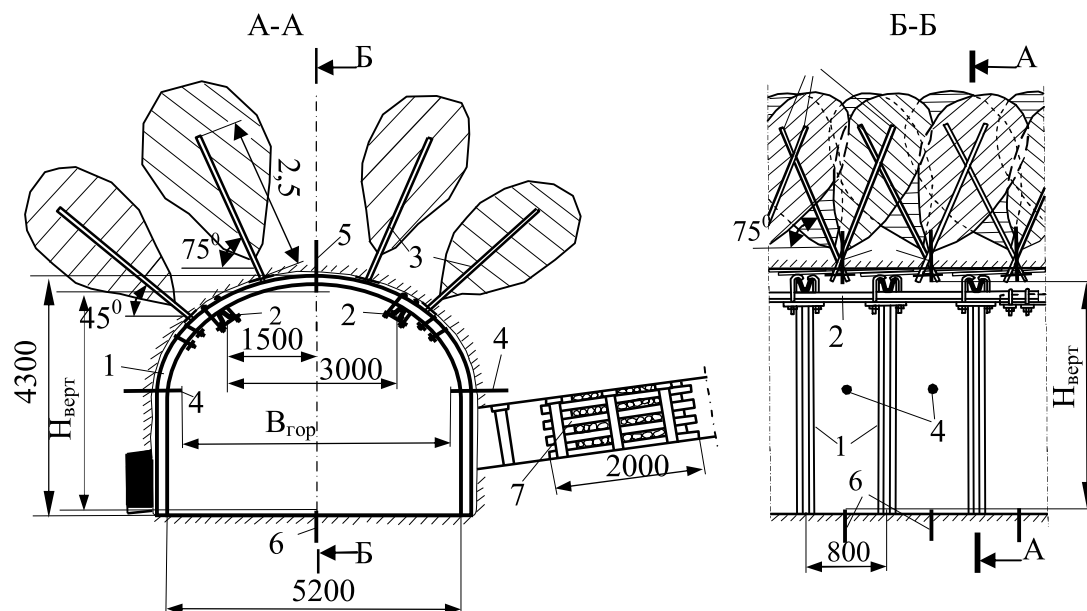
Конструкция двойной продольно-балочной крепи из СВП-27 в сочетании со сталеполимерными анкерами: 1 – арочная крепь; 2 – продольная балка; 3 – сталеполимерные анкеры; 4, 5, 6 – соответственно боковые, верхний и нижний контурные реперы; 7 – буто-костер
